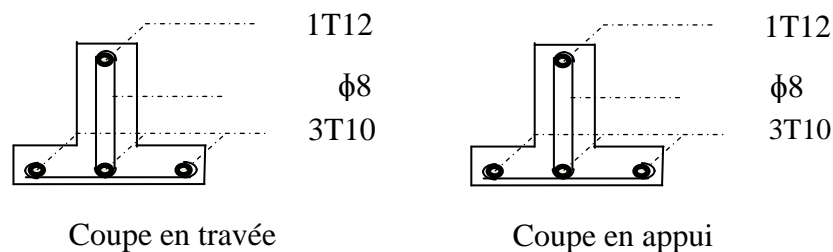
Schémas ferrailage des poutrelles Plancher étage courant (Poutrelles de rive).
